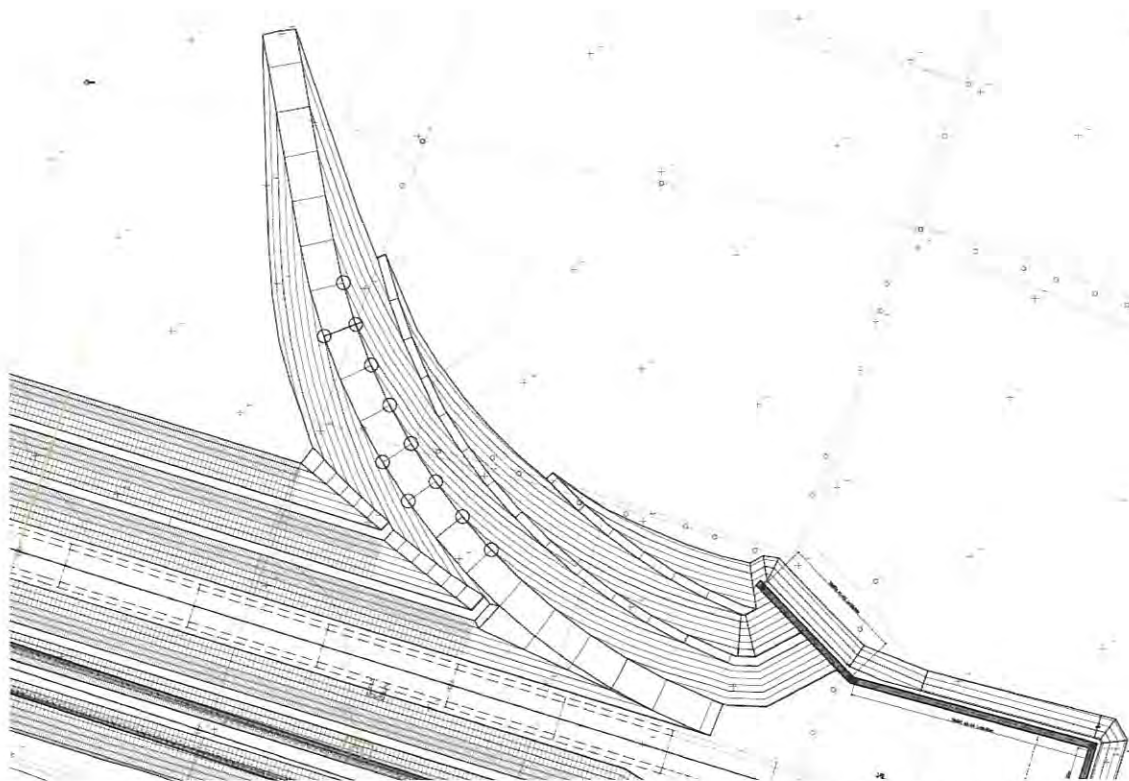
Planimetria della rampa di accesso e sezione tipologica muri ad U
